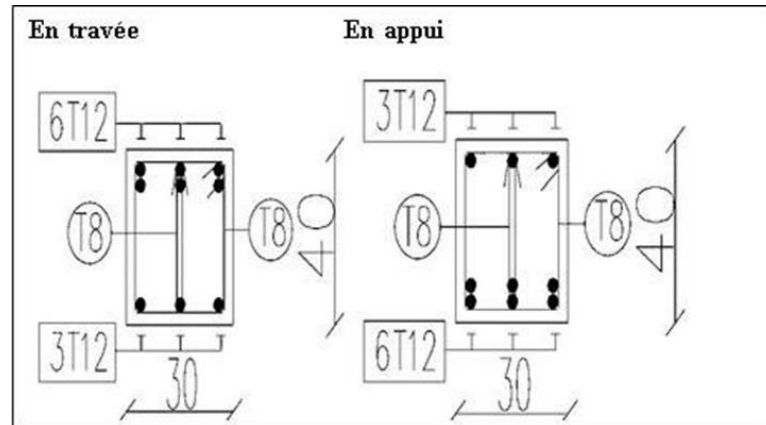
Schéma de ferrailage des poutres principales 30×40
